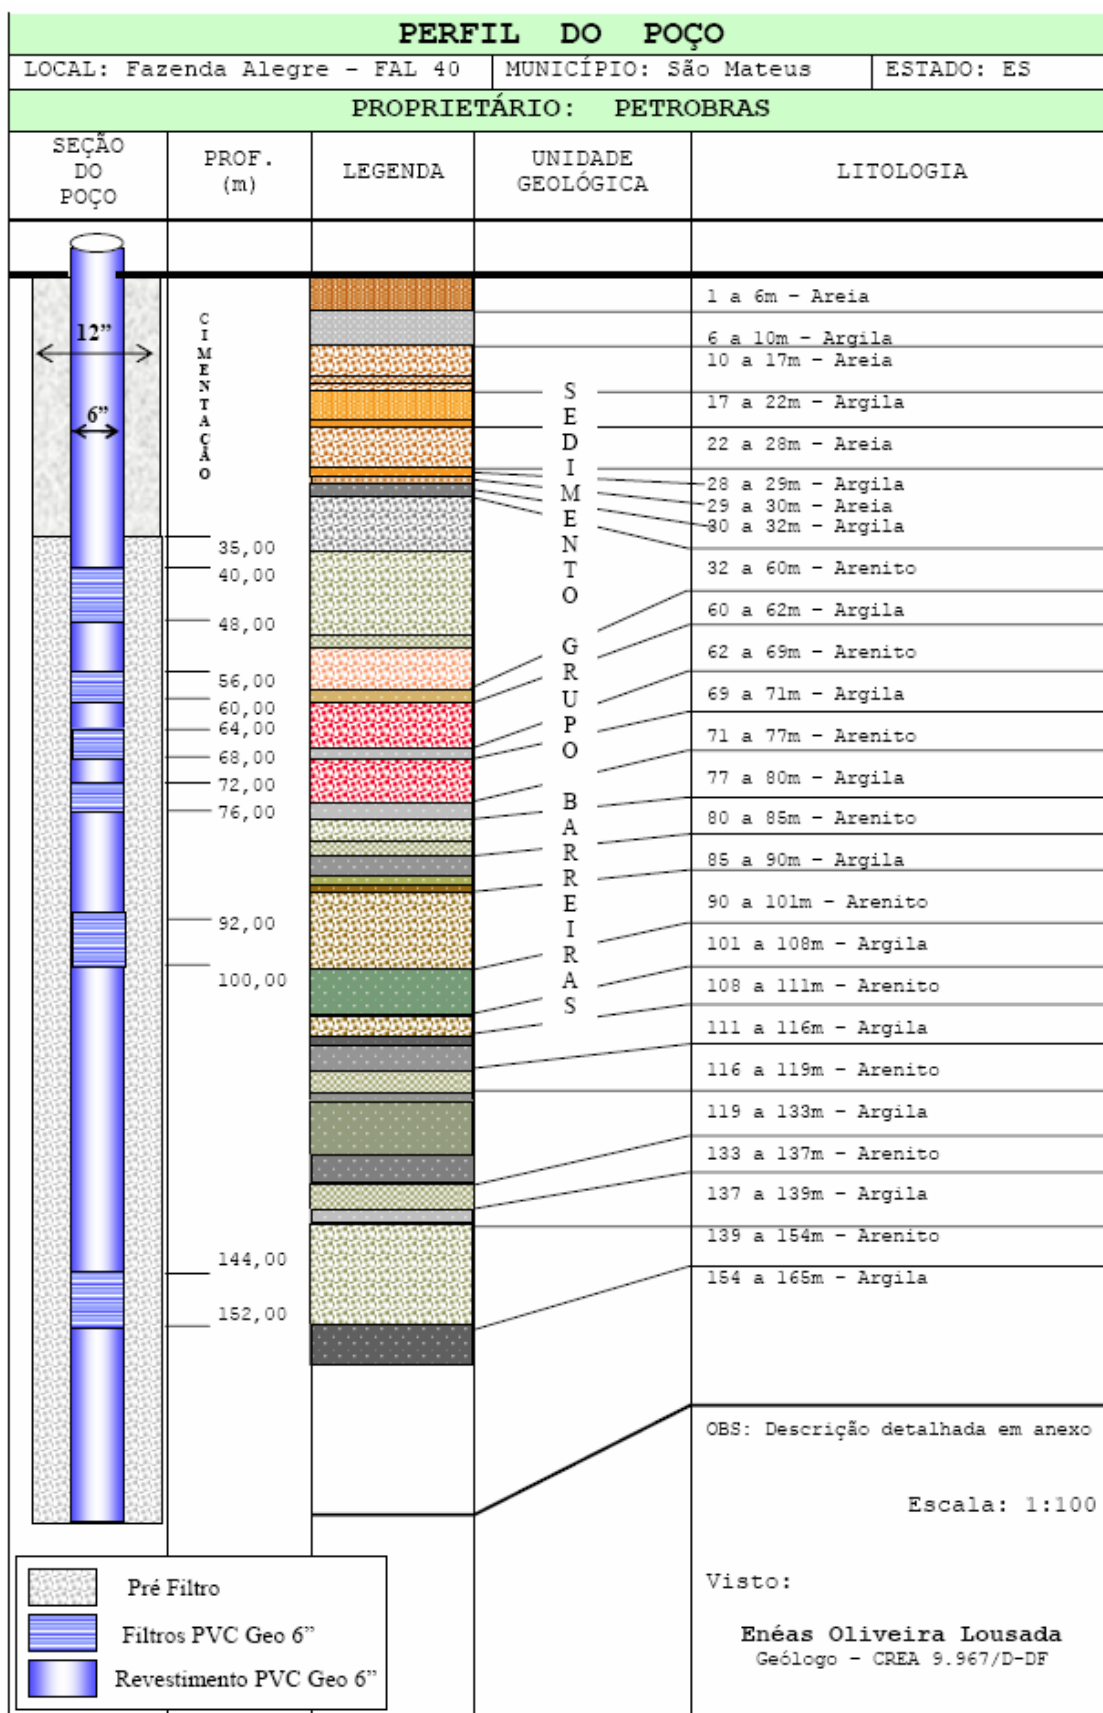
Detalhes construtivos e estratigrafia do poço FAL-40.
